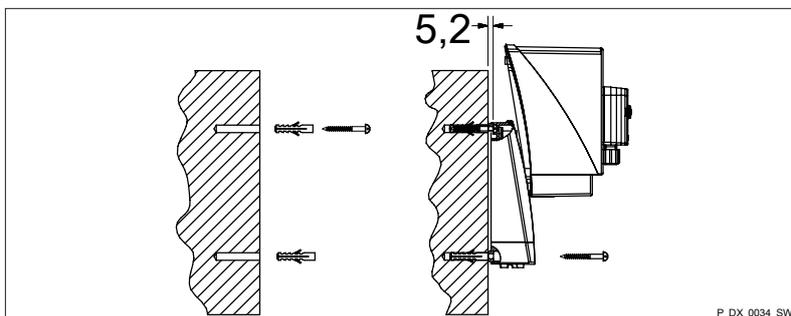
Montage sur un mur, position « parking » - Cotes en mm (pas à l'échelle).
